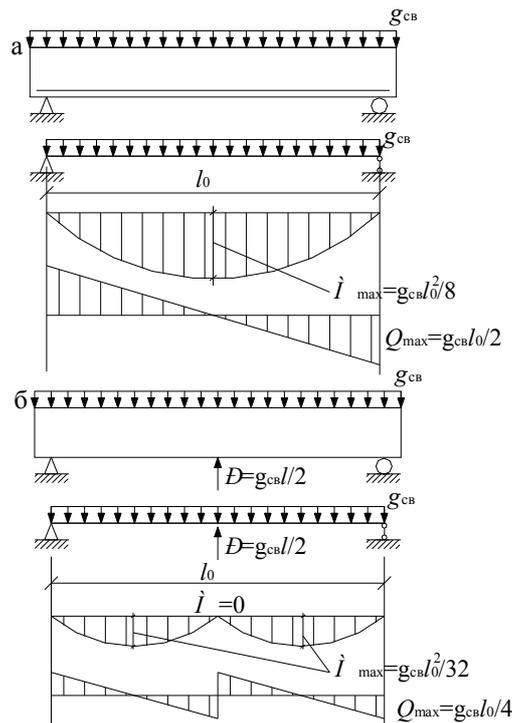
а – схемы загрузки и испытания плиты, эпюры М и Q от собственного веса плиты при опирании на две опоры; б – схемы загрузки и испытания плиты, эпюры М и Q при разгрузке до нулевого момента в середине пролета.
